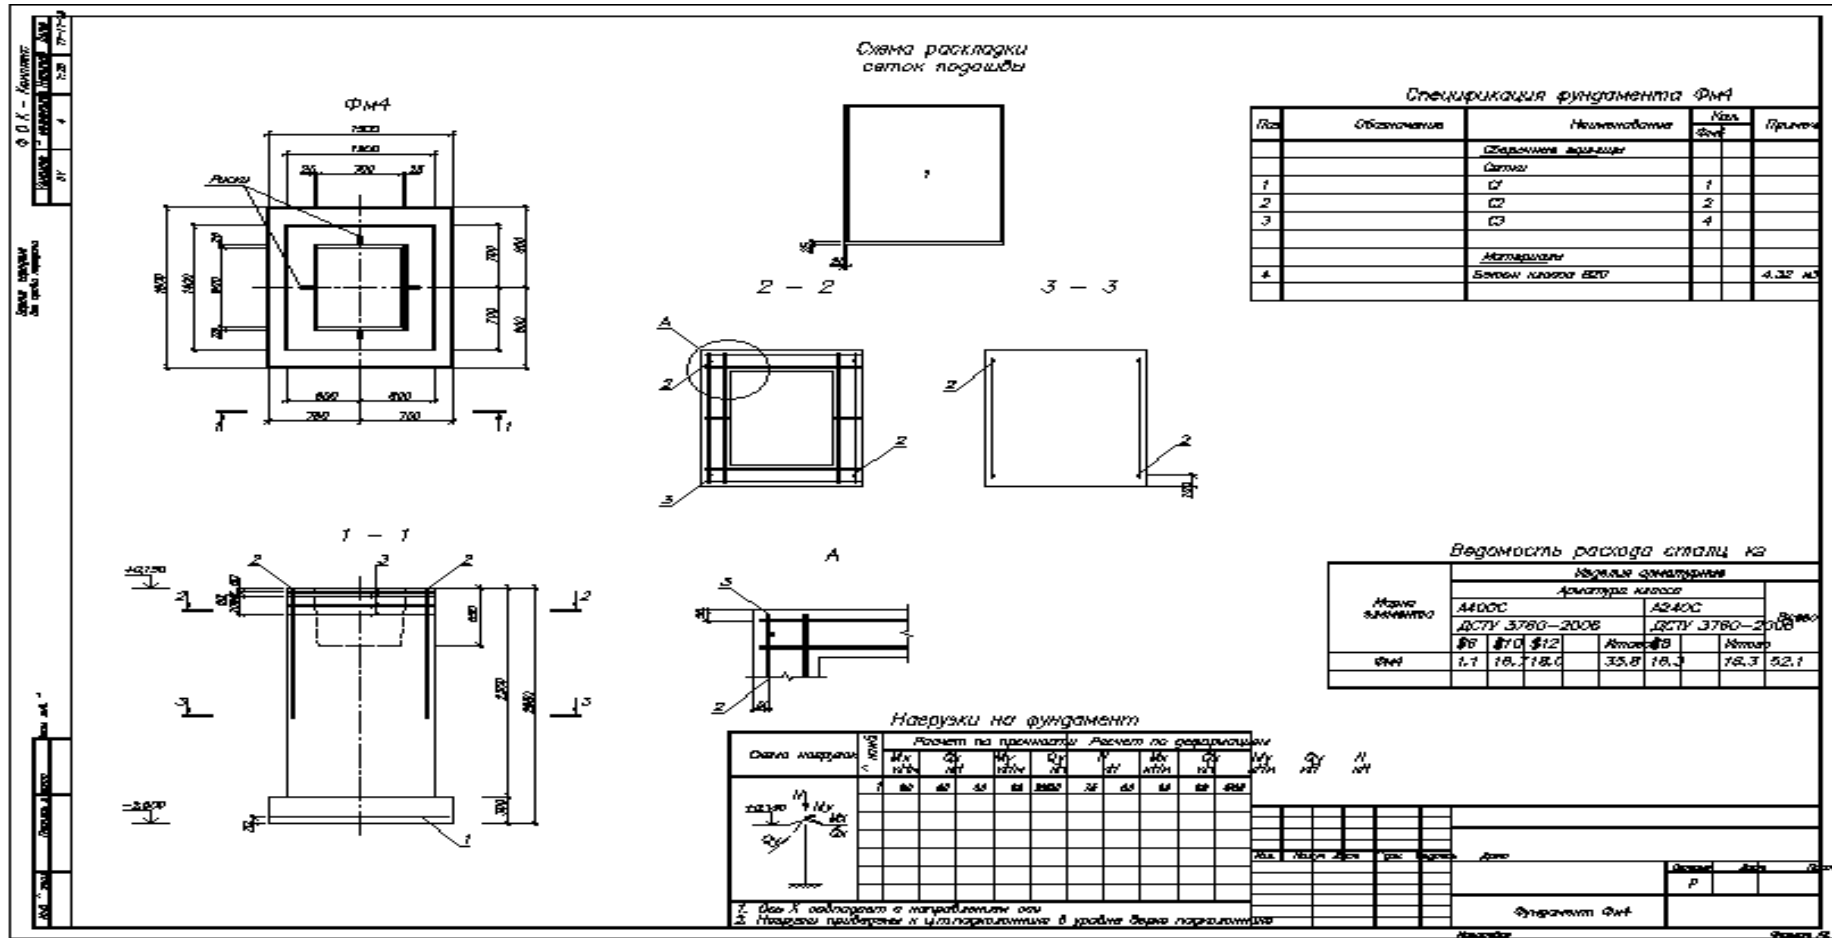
Рама P2. Креслення рабочего проекта. Фундамент під колону 2
